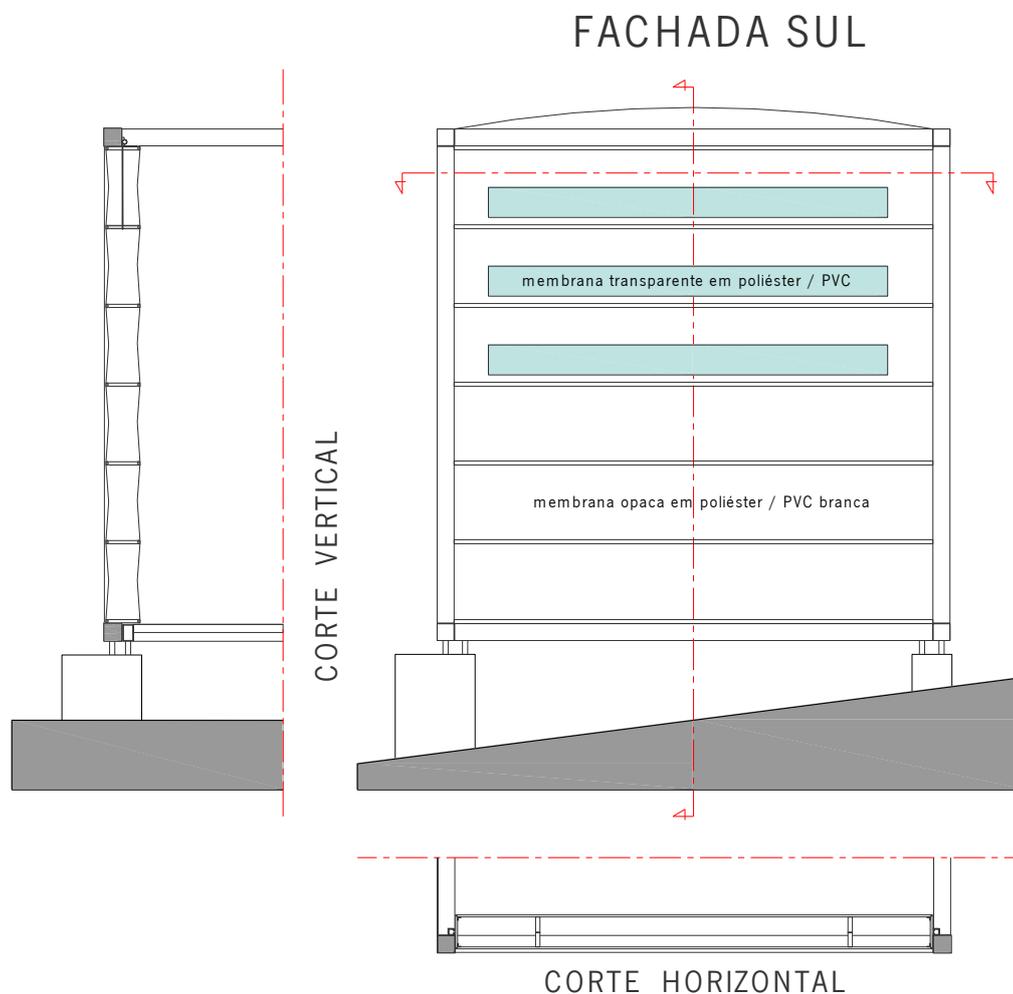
Desenho técnico: *Folder Wall System Facade* aplicada na Célula de Teste no Campus de Azurém da Universidade do Minho. Alçado da fachada sul, corte vertical e corte horizontal do sistema.
